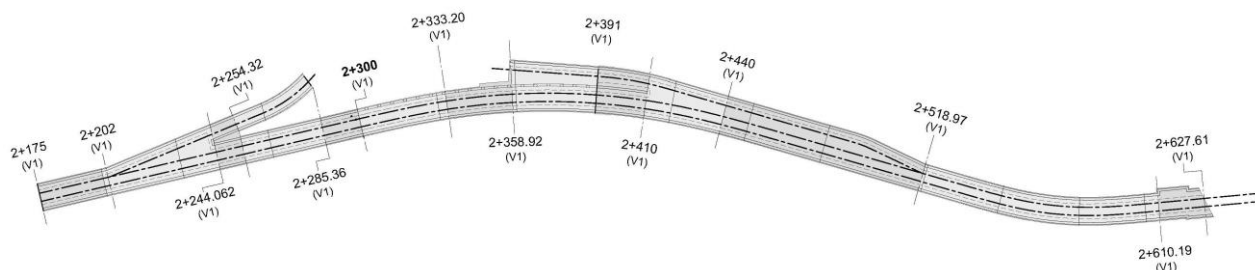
Trincheira coberta entre o km 2+175 e km 2+627.61 - Planta estrutural geral
